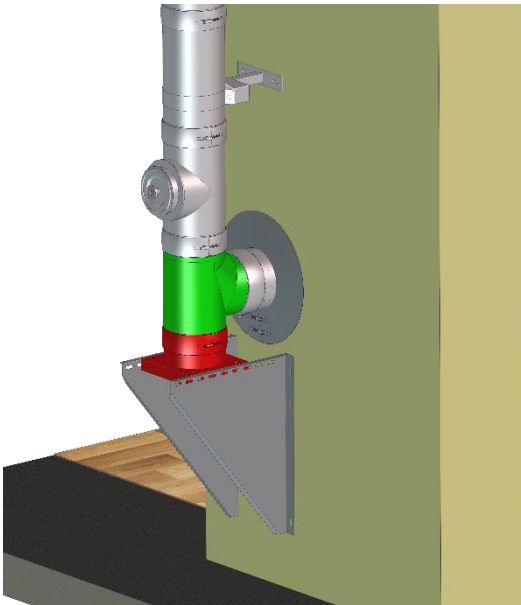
Aufbau mit Grundplatte geschlossen (rot) und Winkel 87° mit Stützfuß (grün)
